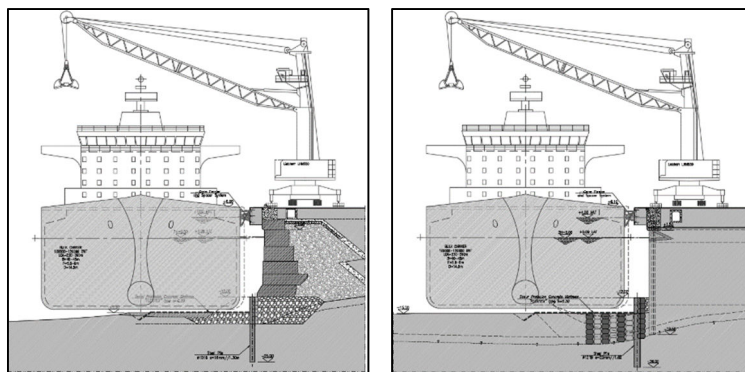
Reforço estrutural/melhoramento de solos: Cais tipo "J" e "L" respetivamente
